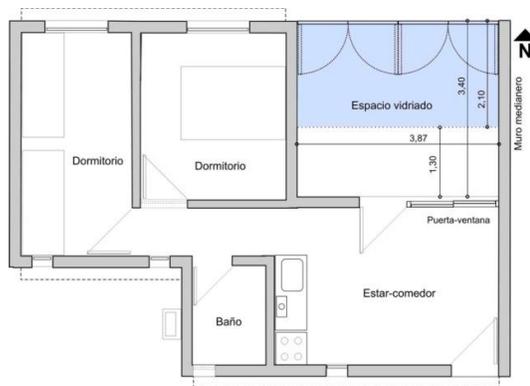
Planta de la vivienda con incorporación del espacio vidriado
